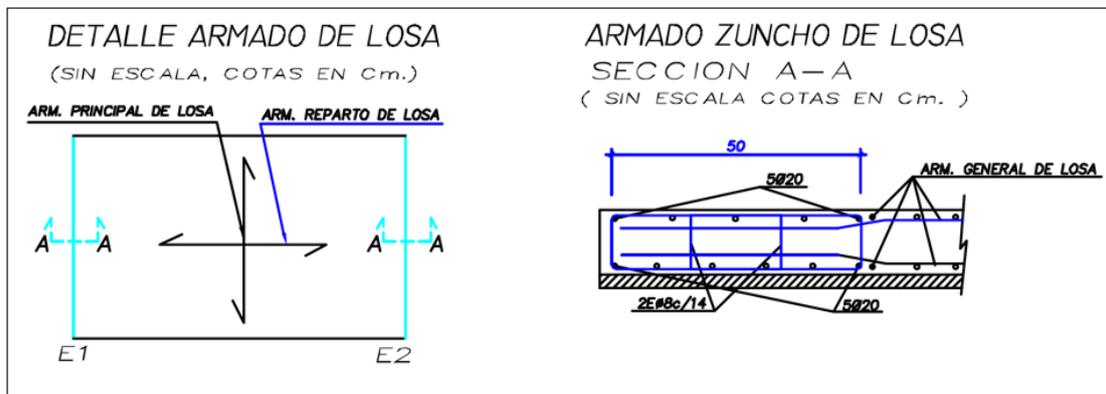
Detalle del reparto de la armadura en la losa y detalle del refuerzo de armadura en los apoyos.
